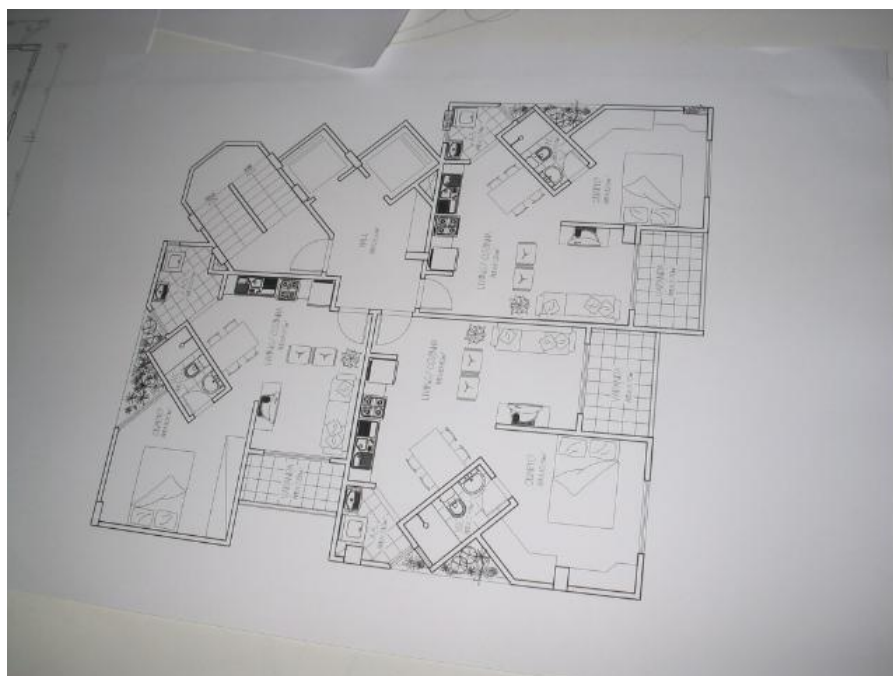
Proposta para edifício. Planta Baixa. Ateliê III - Turma B. Aluna: Ana Maria.
